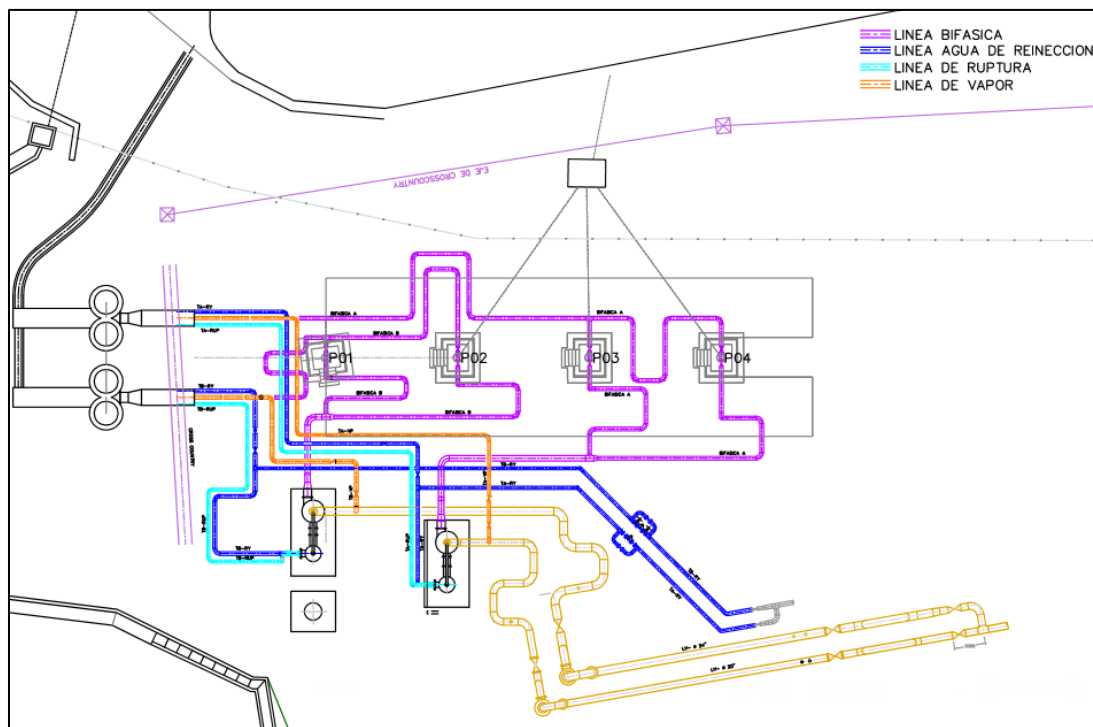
Vista de planta de disposición de sistema de acarreo en plataforma DG-01.
